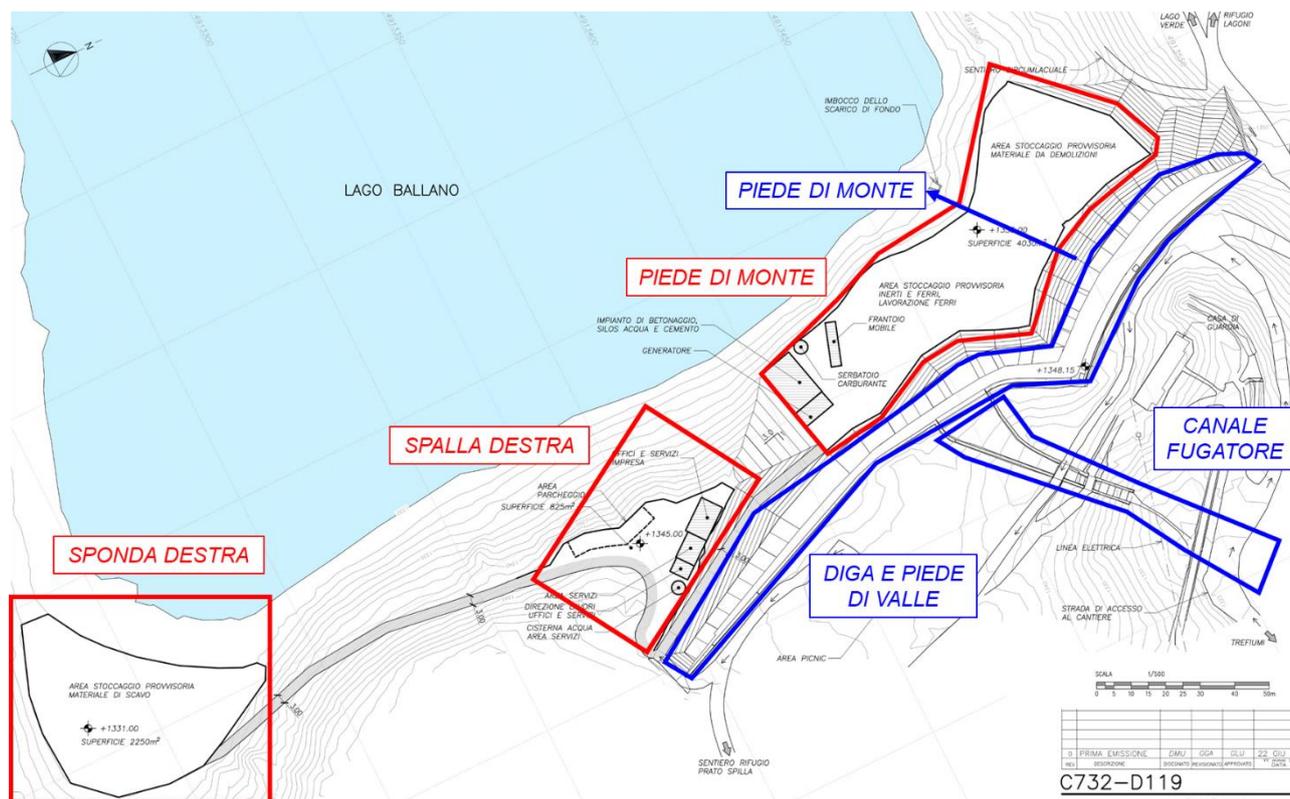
In rosso le aree di cantiere e in blu le aree di lavoro
